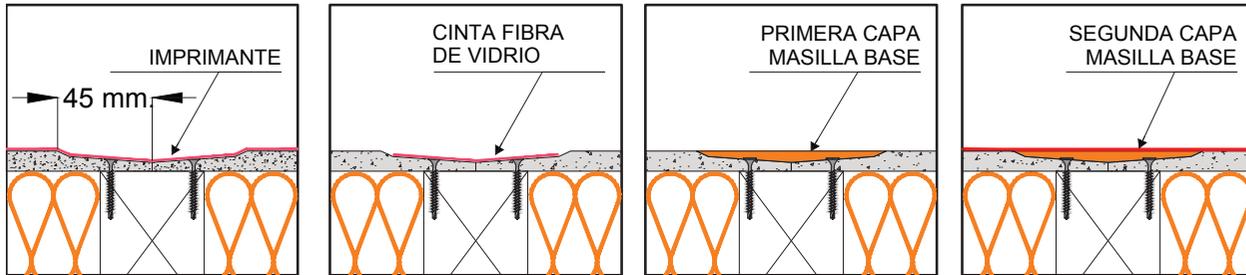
Detalle de tratamiento de junta invisible en planchas de fibrocemento (Fuente: CDT).
